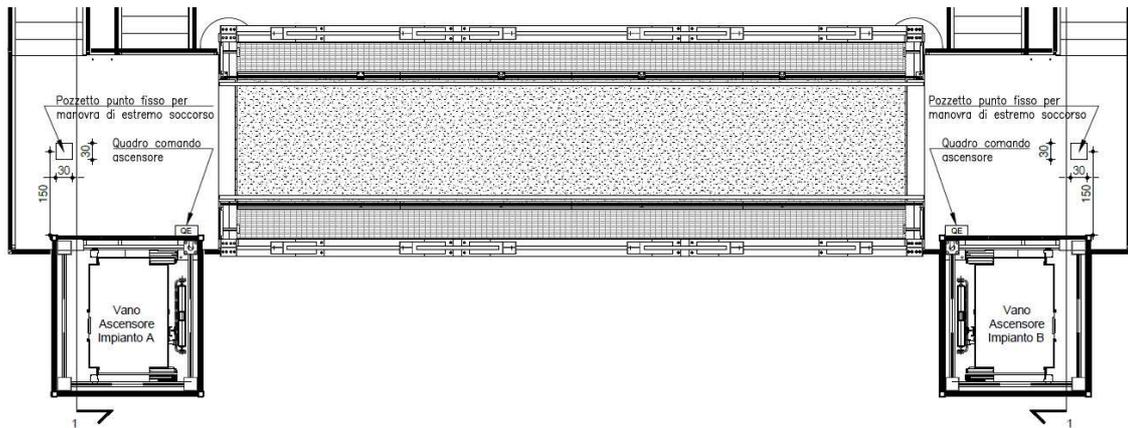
Estratto planimetria impianti ascensori a quota passerella
